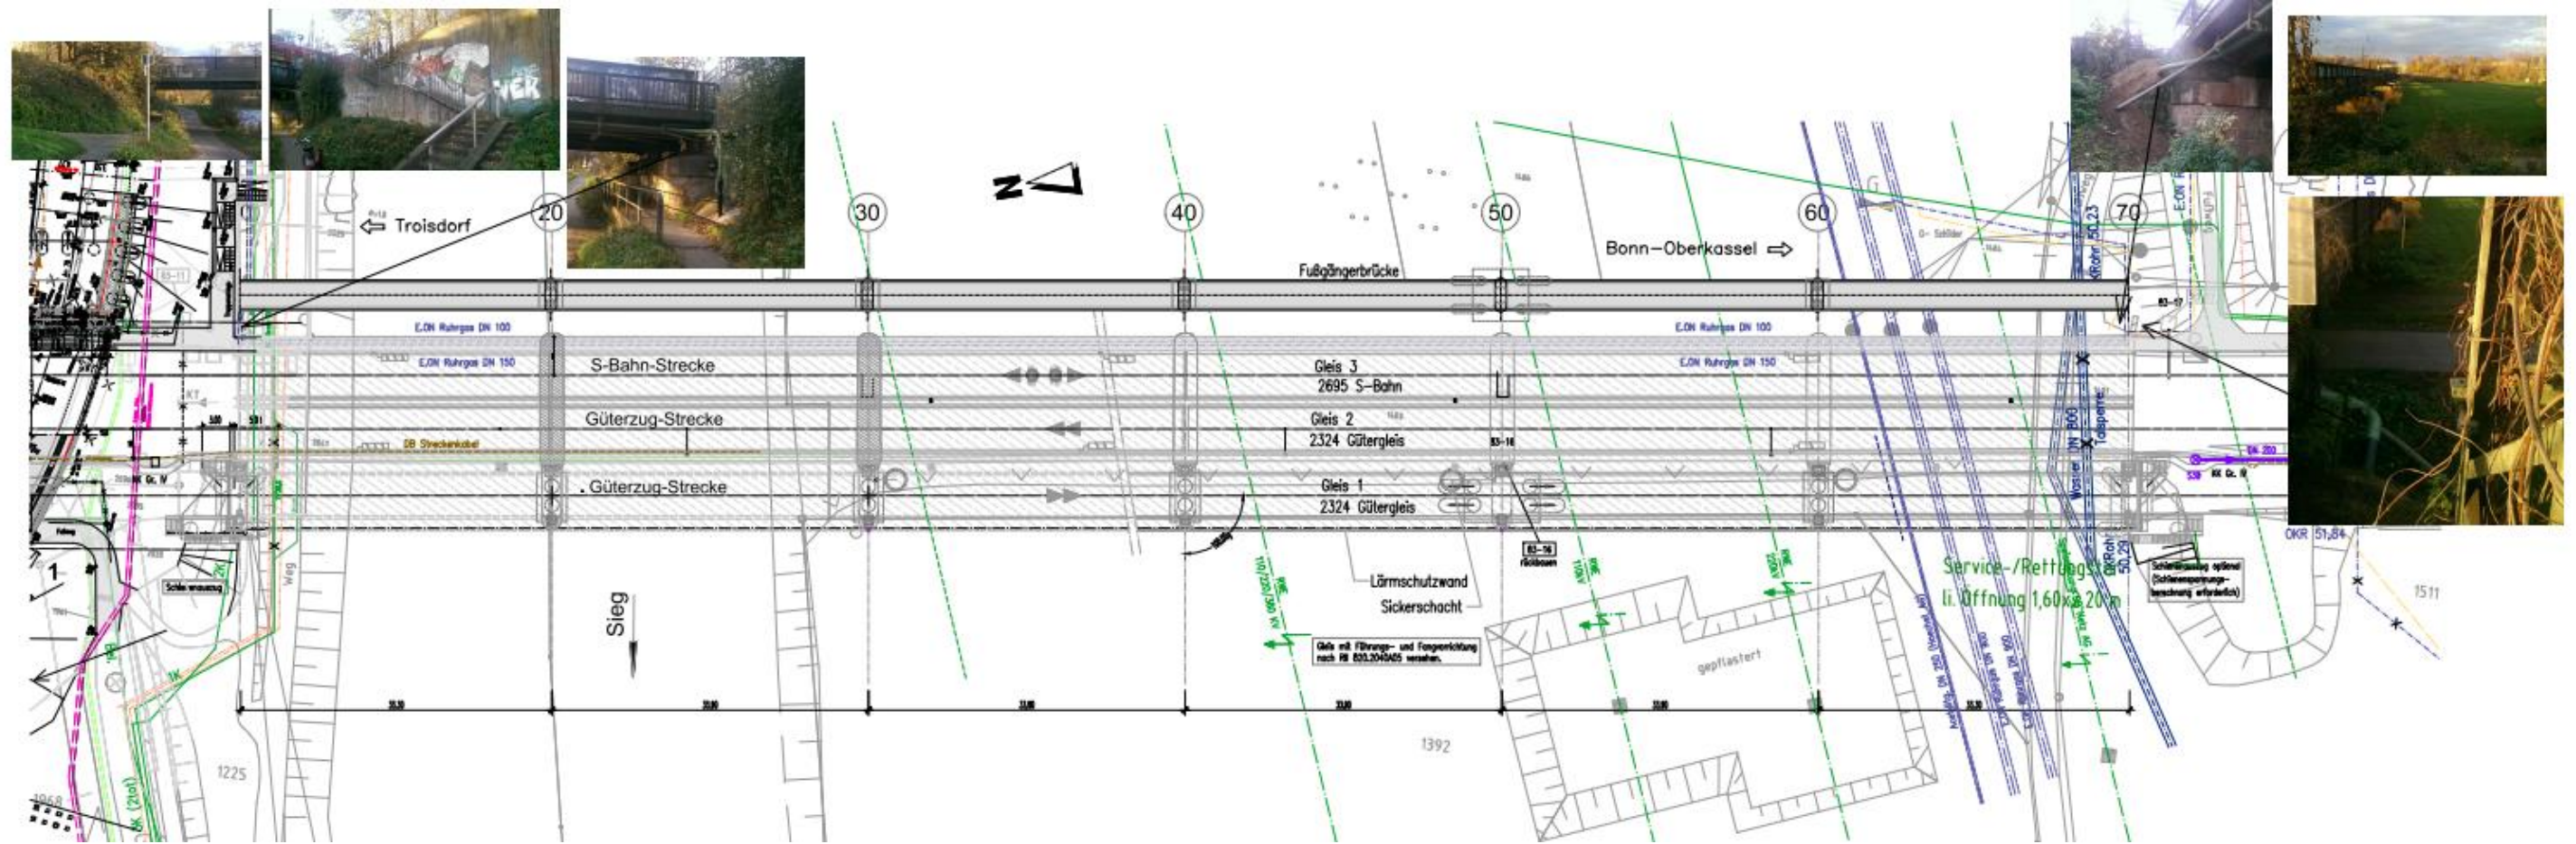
Grundriss_Variante IIa - Ostseite
